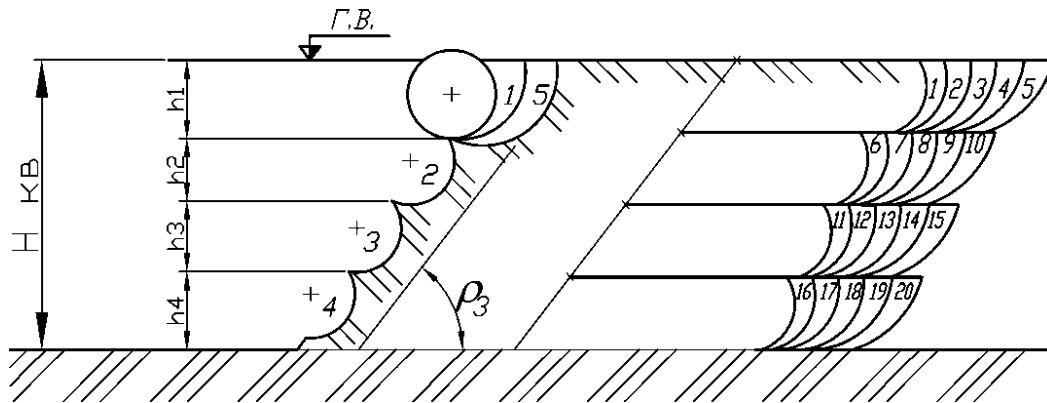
Способ обработки уступа фрезерно-шнековым земснарядом вертикальными стружками
